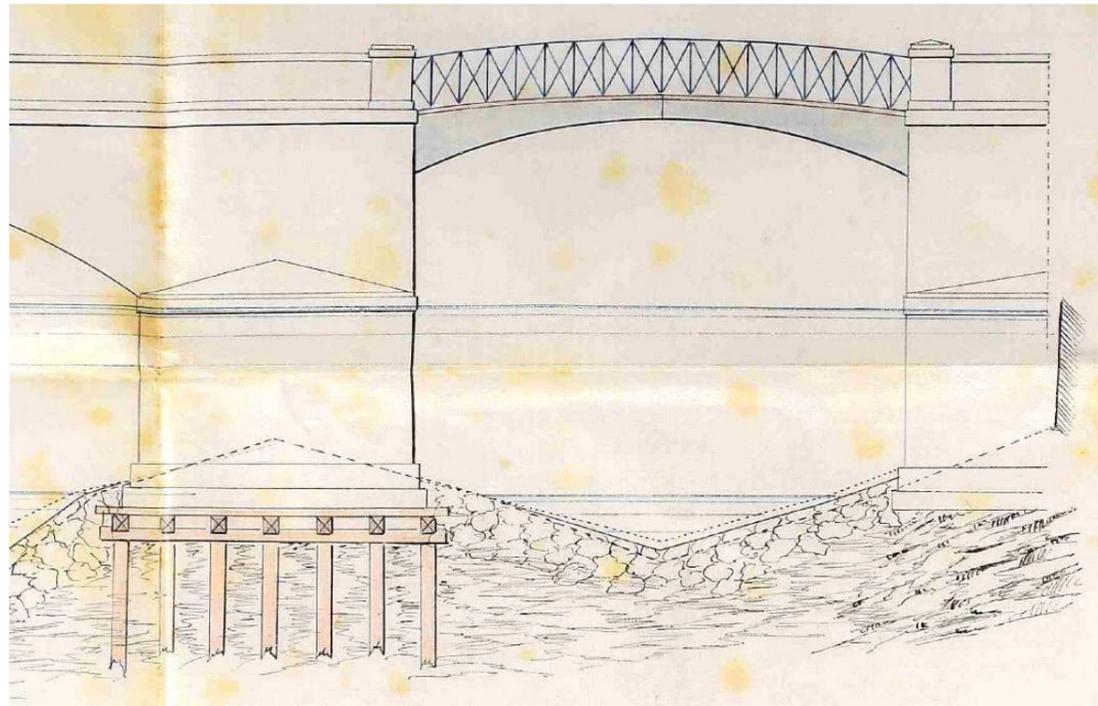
Alzado de aguas abajo del tramo 4, tomado de los planos del proyecto de reparación de 1892-1893, donde se observa la cimentación de la pila 3 y el estribo 2.
